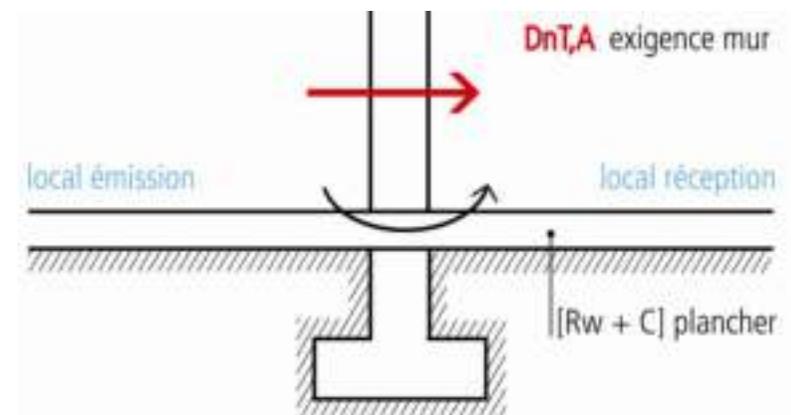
Dalle continue sur terre-plein et mur lourd simple.
